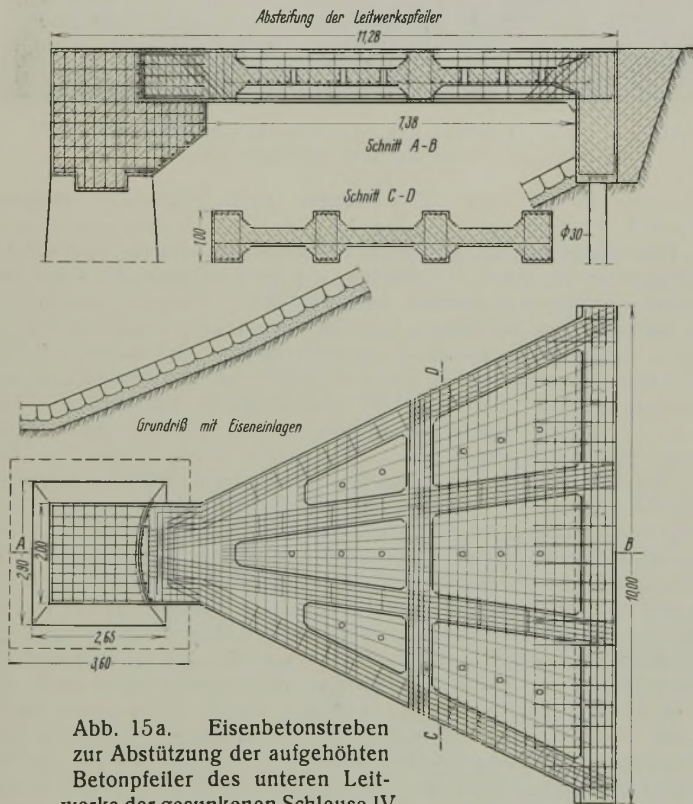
Eisenbetonstreben zur Abstützung der aufgehöhten Betonpfeiler des unteren Leitwerks der gesunkenen Schleuse IV.
